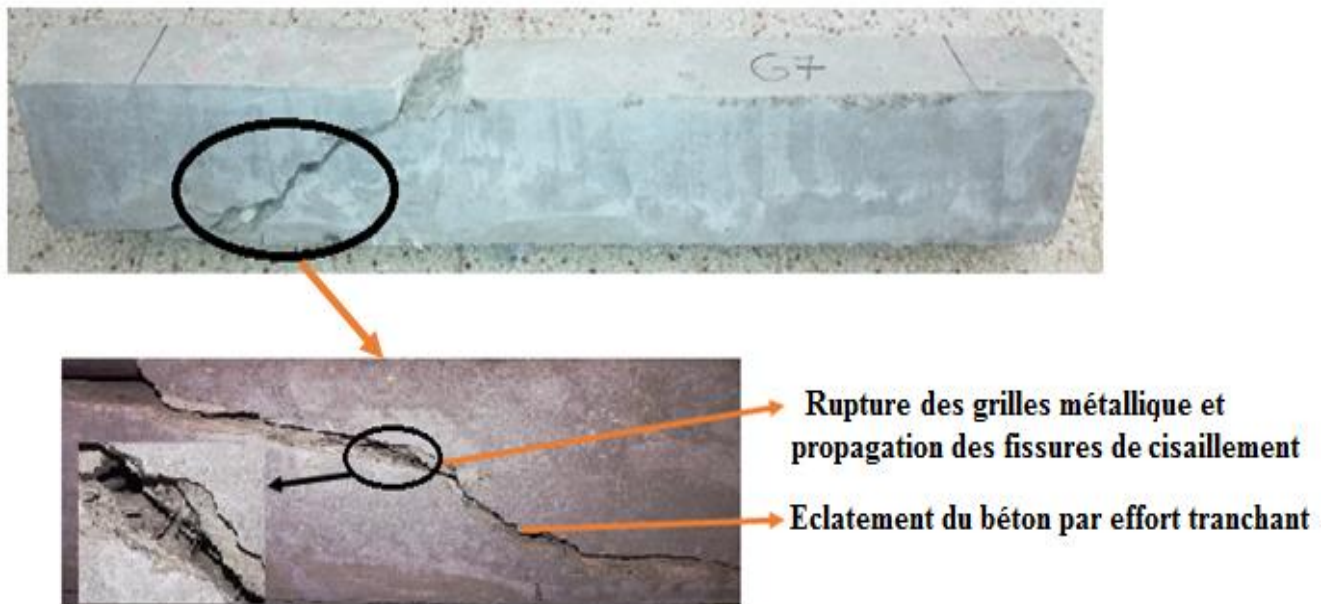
Mode de rupture des poutres renforcées du groupe 03 (poutre MIEL (03)).
